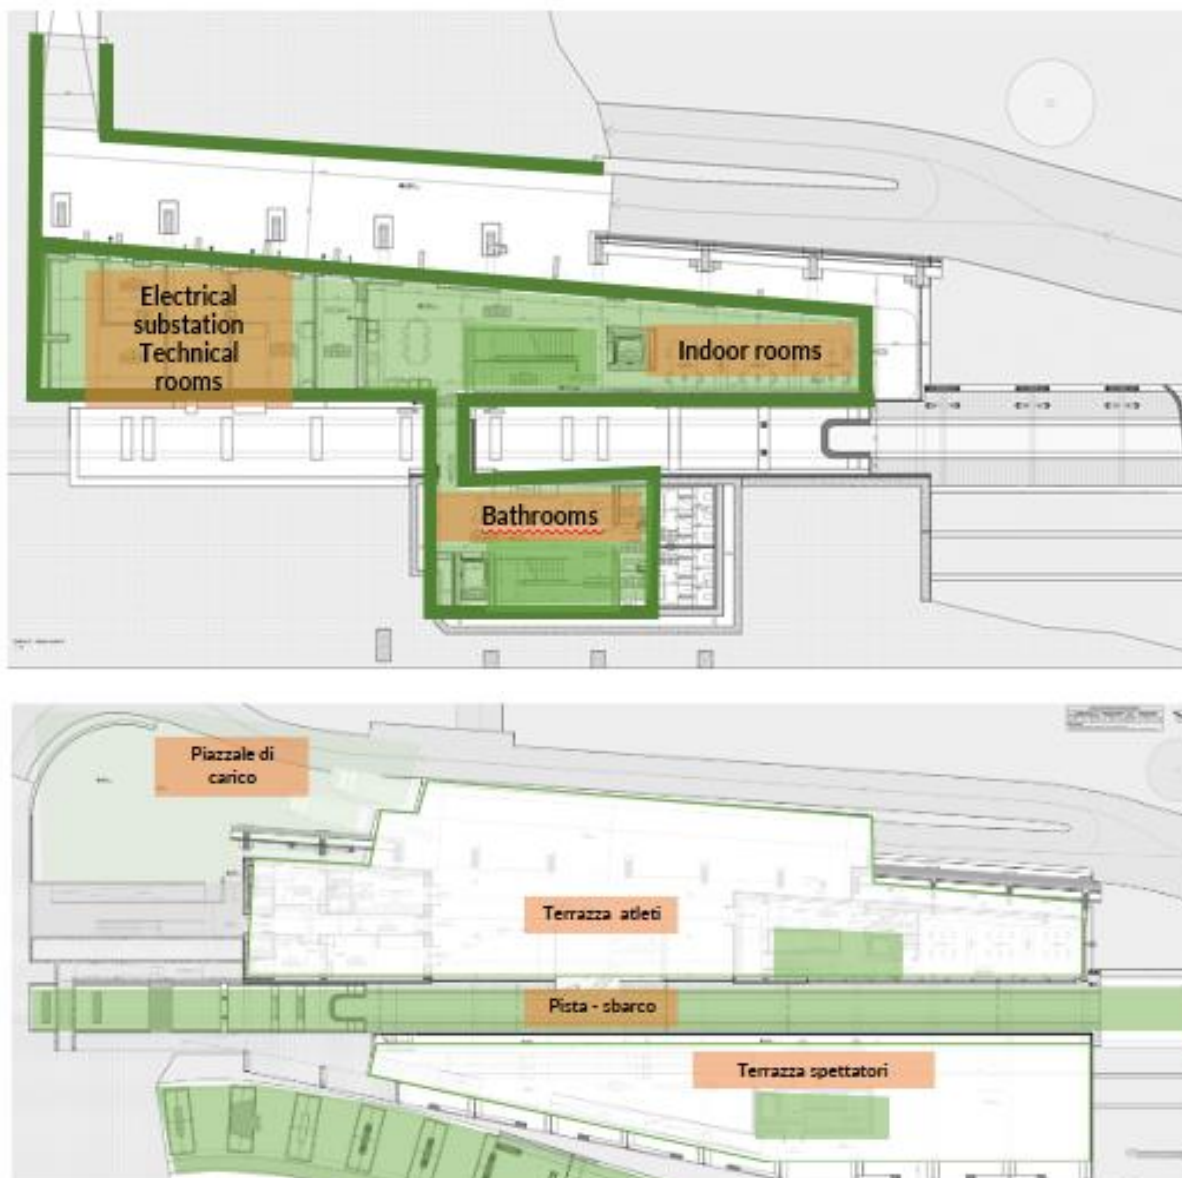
In alto pianta piano terra, in basso pianta piano primo (terrazza). In verde, le parti confermate nell'aggiornamento del progetto
